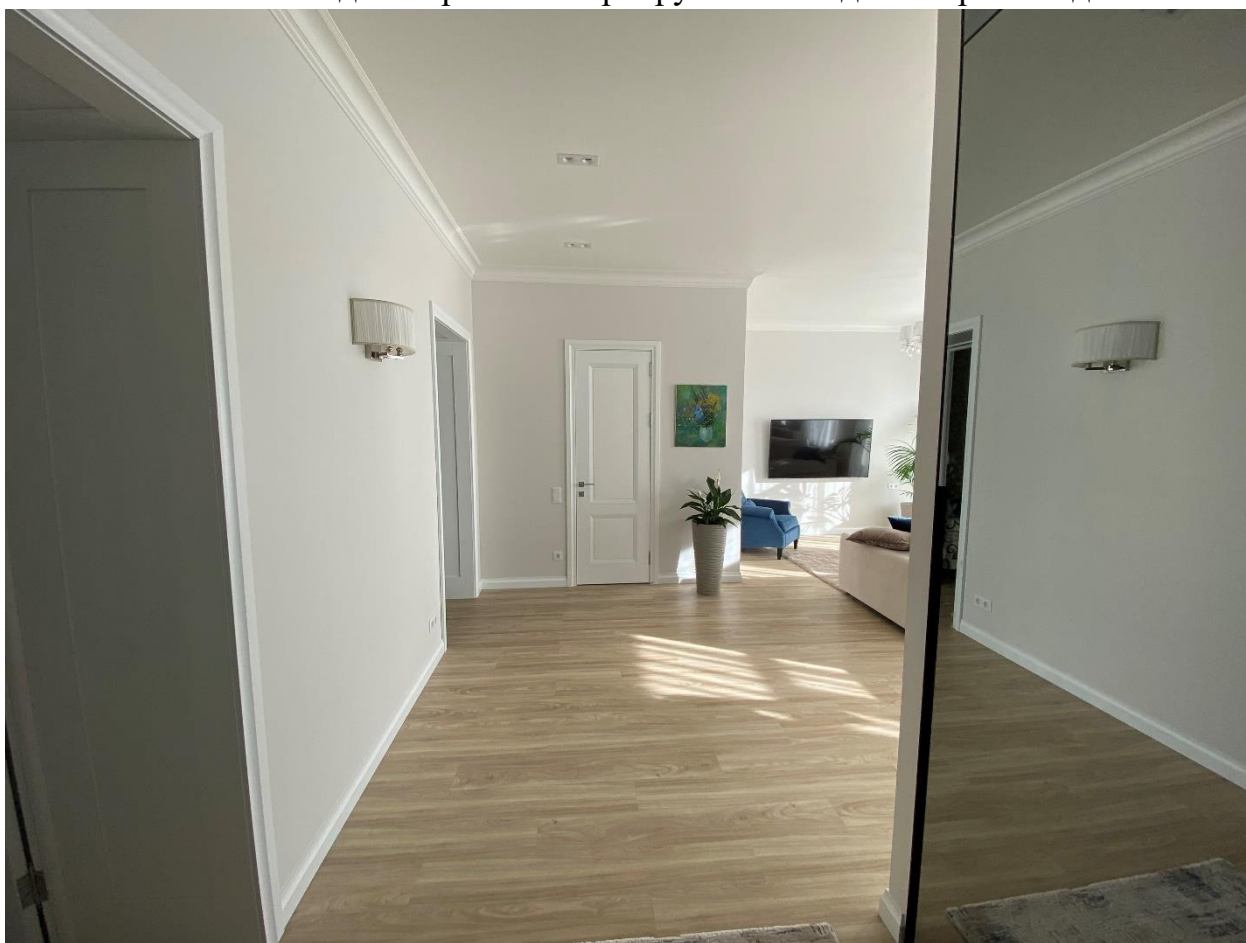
Помещение № 1 согласно плану ПИБ. Вид с северо-запада
